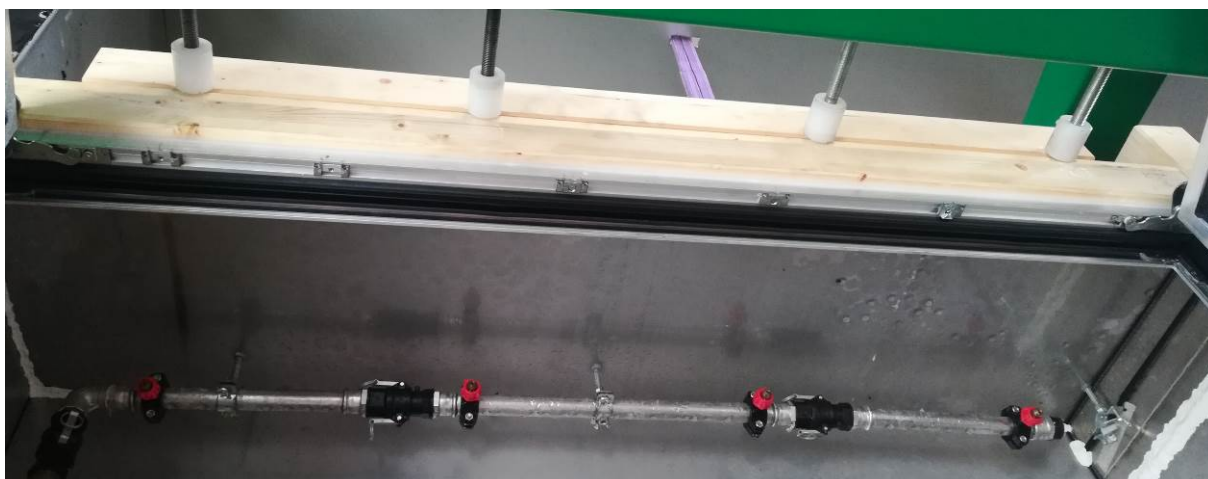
, Foto 13 e Foto 14. Dettaglio degli accessori e delle asole di scarico del campione sottoposto a prova
